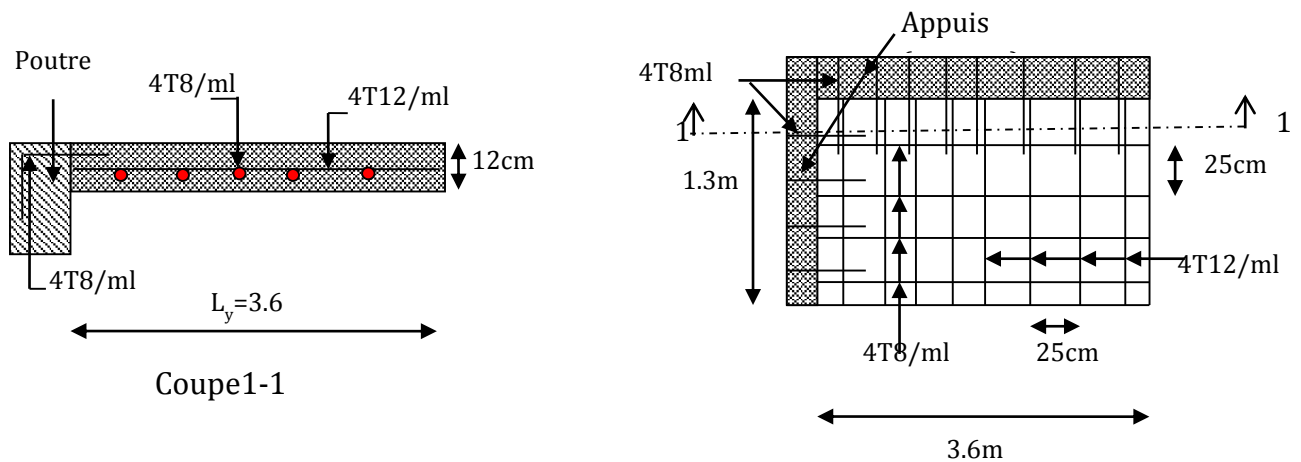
schéma de ferrailage dalle pleine deux appuis (balcon).
